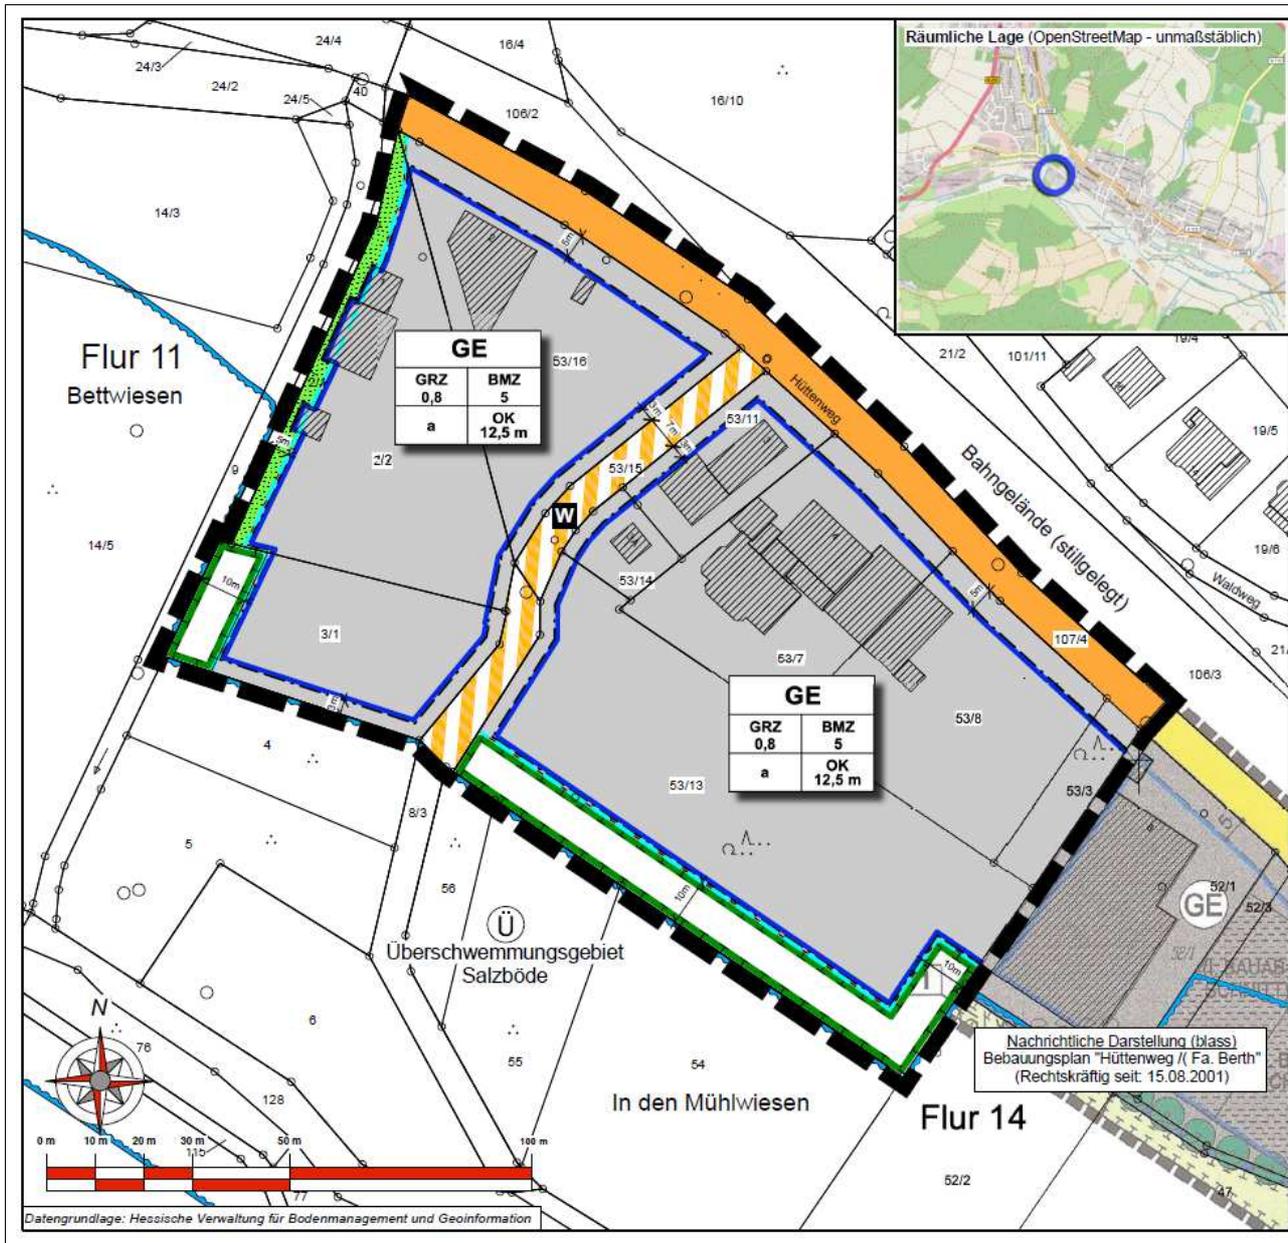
Bebauungsplan Vorentwurf (Groß und Hausmann).
